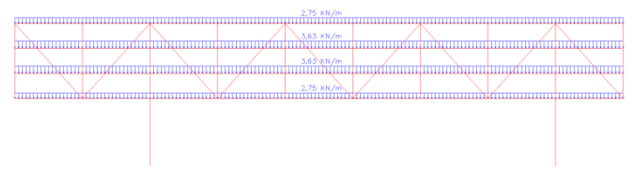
Esquema cargas permanentes lineales fachada sur.
